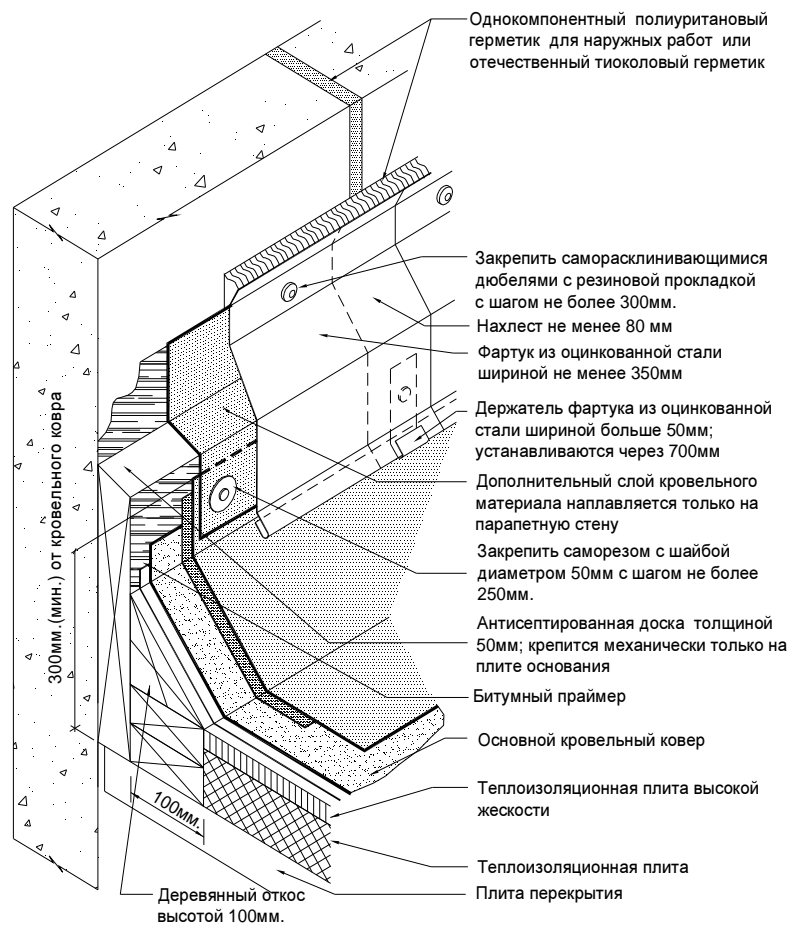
Примыкание кровельного ковра к парапетной стене из бетонных блоков.
